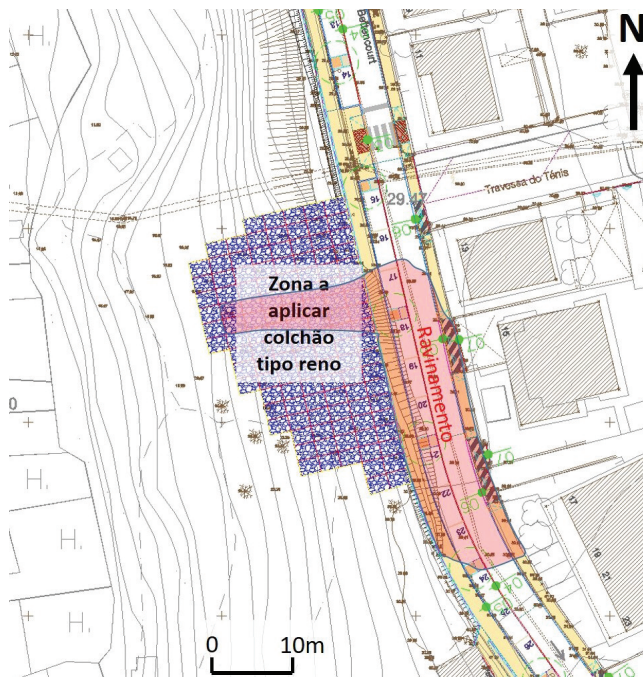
Planta da zona a aplicar o colchão tipo Reno, sobre as areias eólicas.
